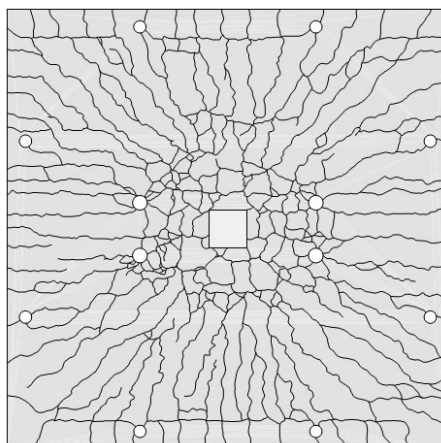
Fissuras devidas ao momento fletor em regiões de ligação laje-pilar (Laje PG 20 de GUIDOTTI, 2010)
